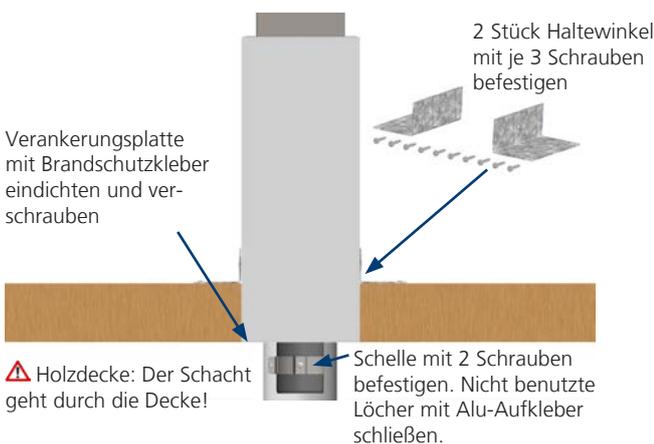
Detail Holzdeckengestützter Anschluss in DN 60/100 oder DN 80/125
